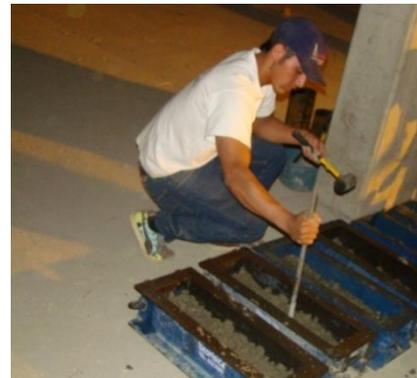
Toma de vigas y cilindros para el pavimento rígido
